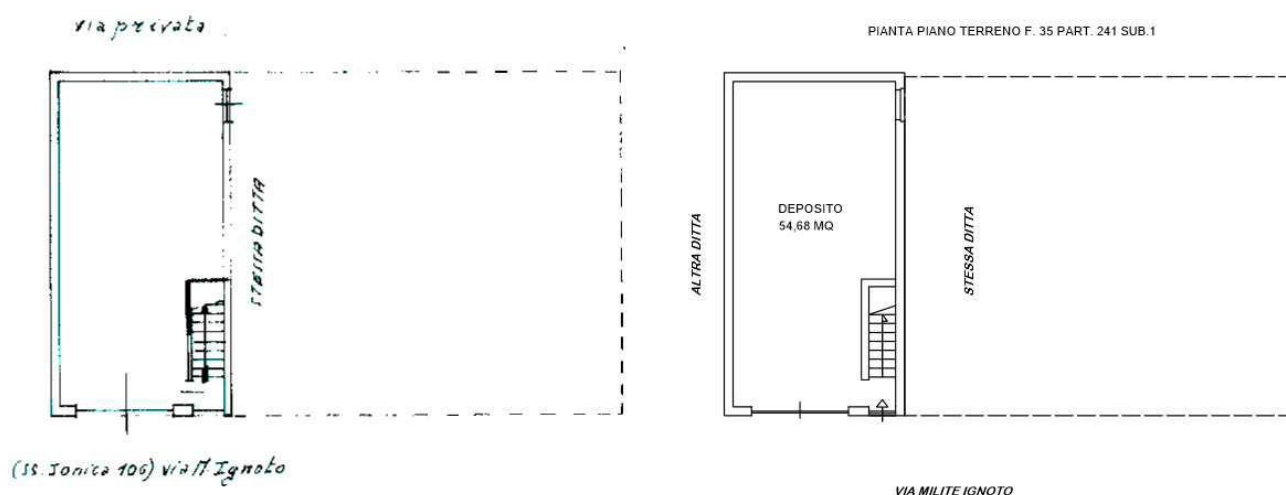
Planimetria catastale e stato di fatto del Piano Terreno
